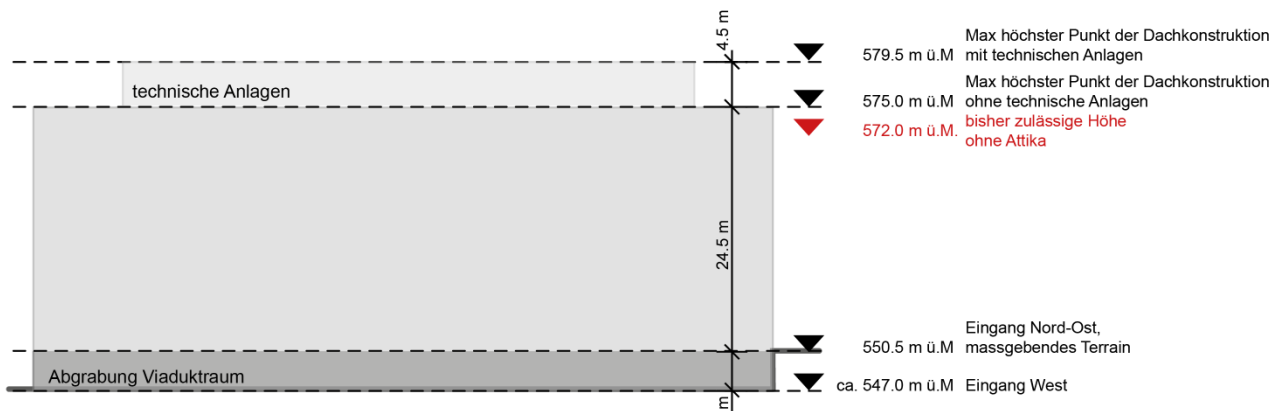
Neue Regelung Fassadenhöhen Baubereich A Campus (Stadtplanungsamt Bern 2020)
